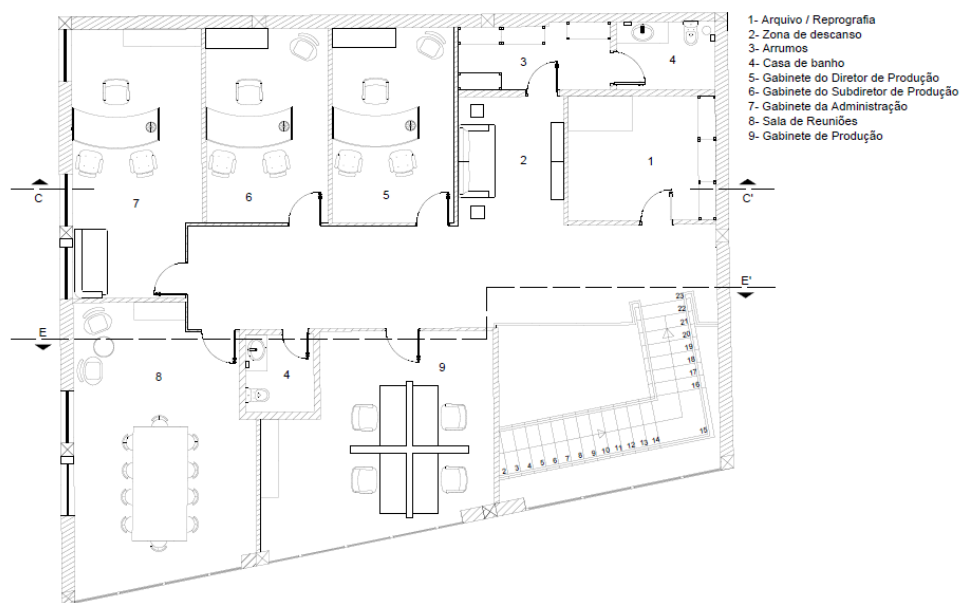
Planta de apresentação do piso 1, em Autocad. *Fonte:* Agrocinco.
